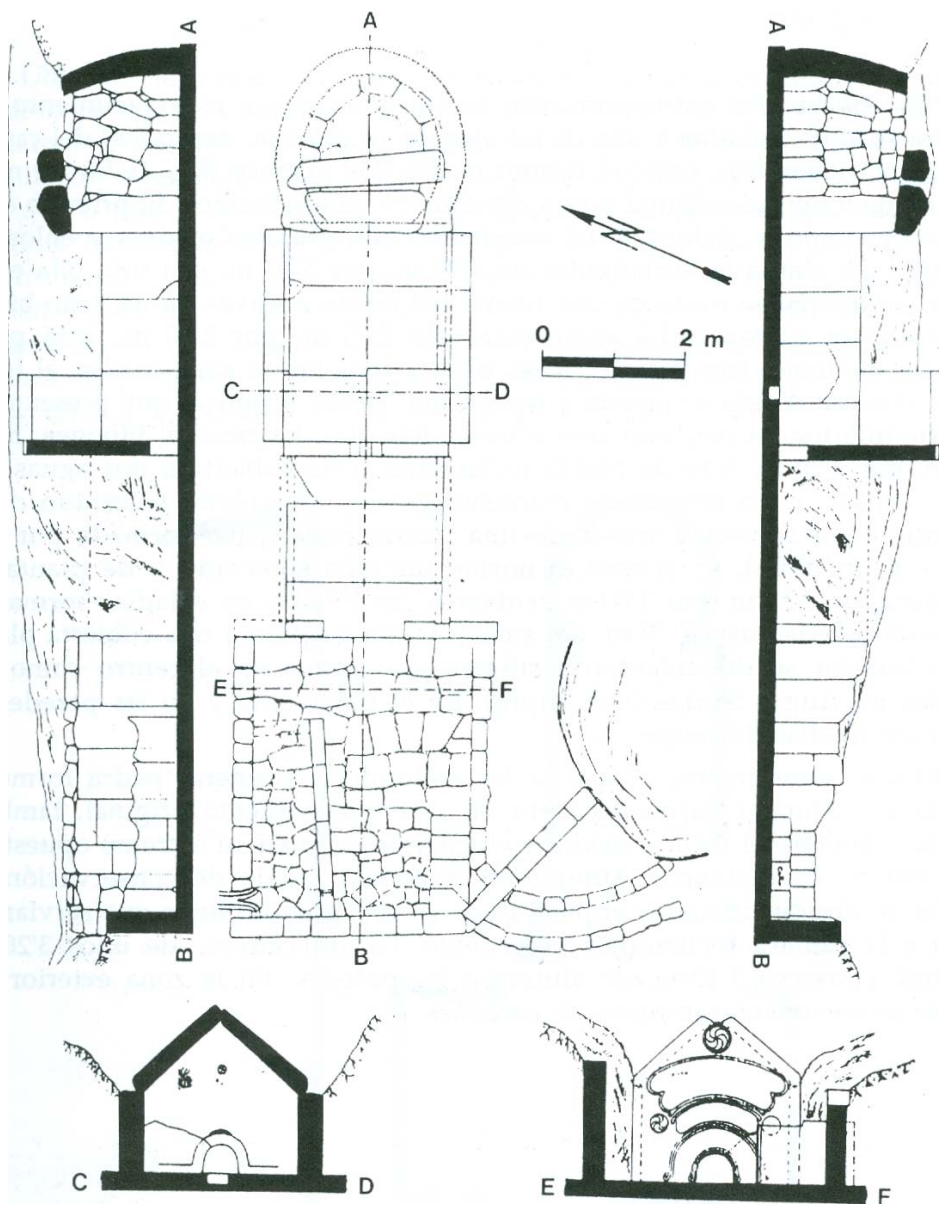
Planta, alzado y secciones de la «sauna» de Briteiros 1 (Cardozo, 1990).
